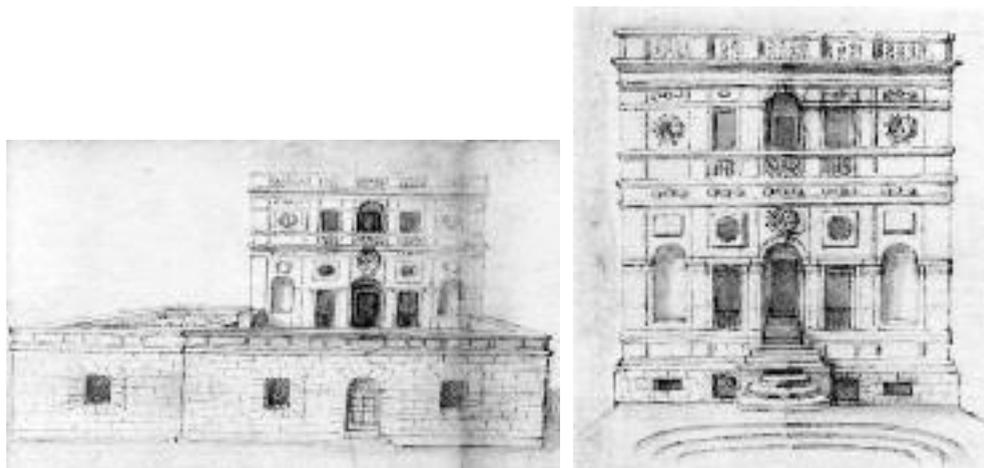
Plautilla Bricci, *Prospetto meridionale, affacciato sulla Via Aurelia Antica, e prospetto settentrionale del Casino del Vascello*, 1663, Roma, Archivio di Stato.
